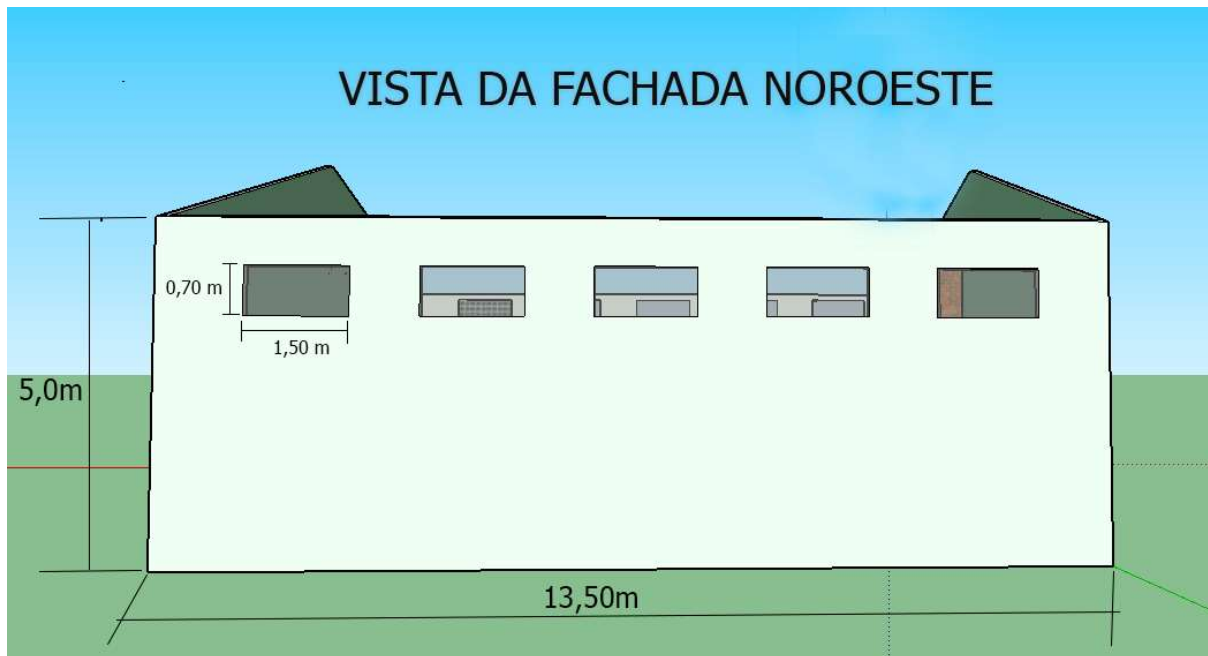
Características dimensionais da fachada noroeste da edificação.
